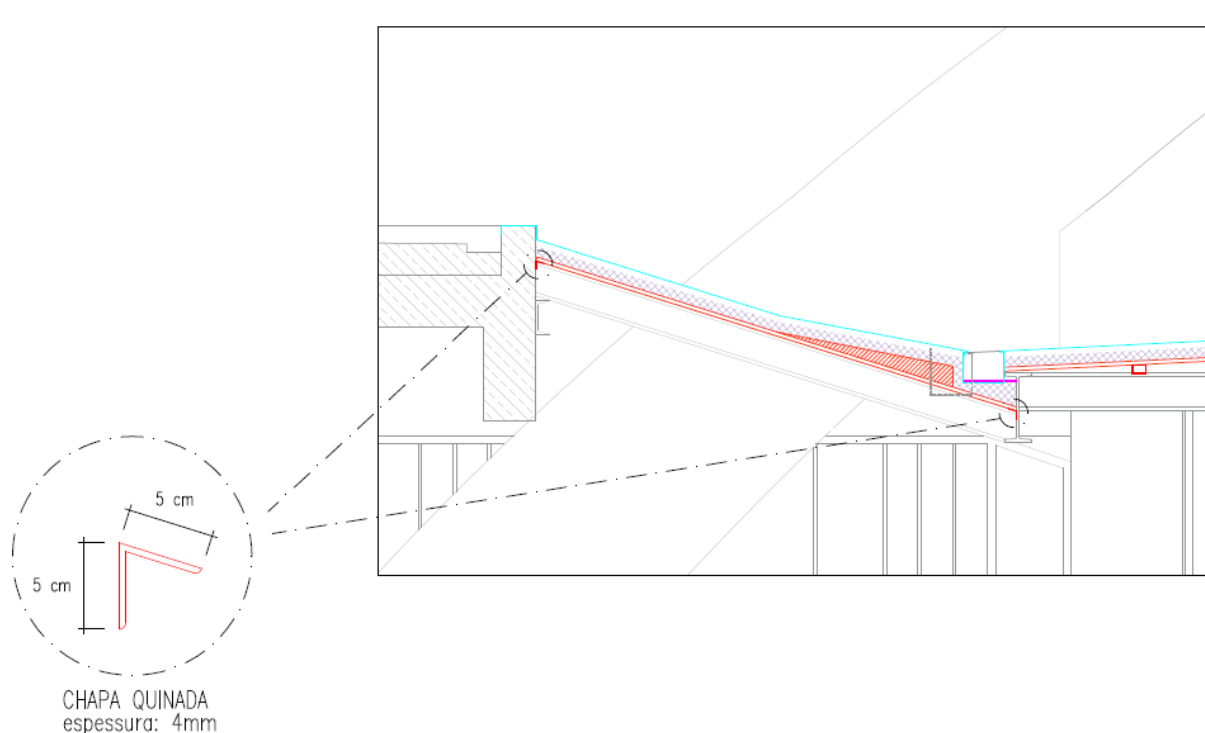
Pormenor de execução da secção 3 (2015)
